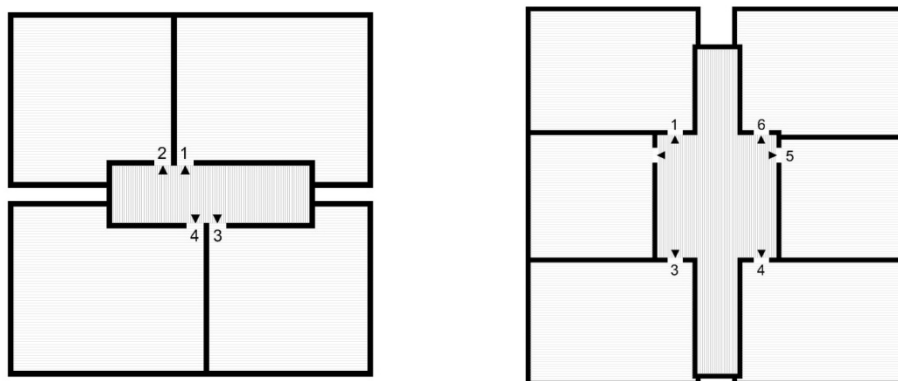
Izquierda: Torre con núcleo central y 4 viviendas por rellano. Derecha: Torre con núcleo central y 6 viviendas por rellano
